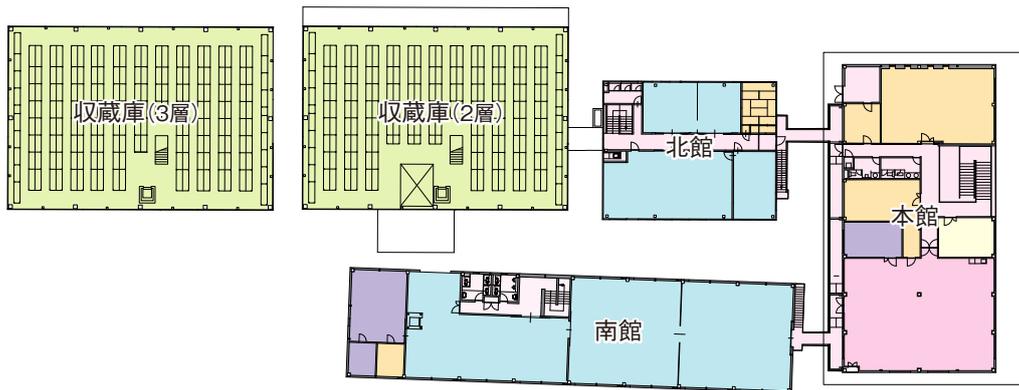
高知県立埋蔵文化財センター 2F 平面図(S=1/800)
